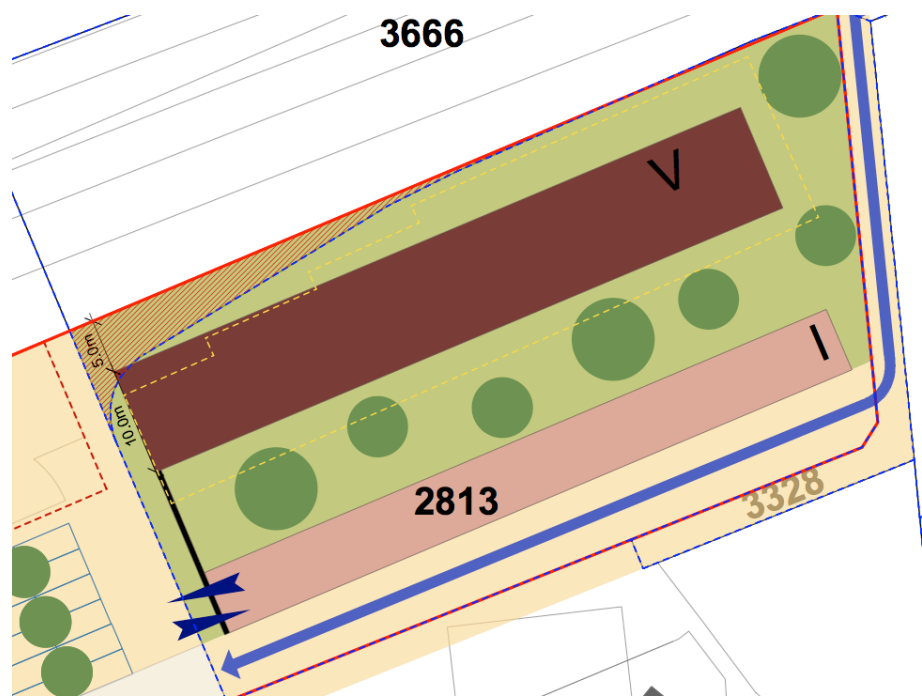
Planskizze mit möglicher Optimierung der Parzellenstruktur (Quelle: PLANAR, 2016)
